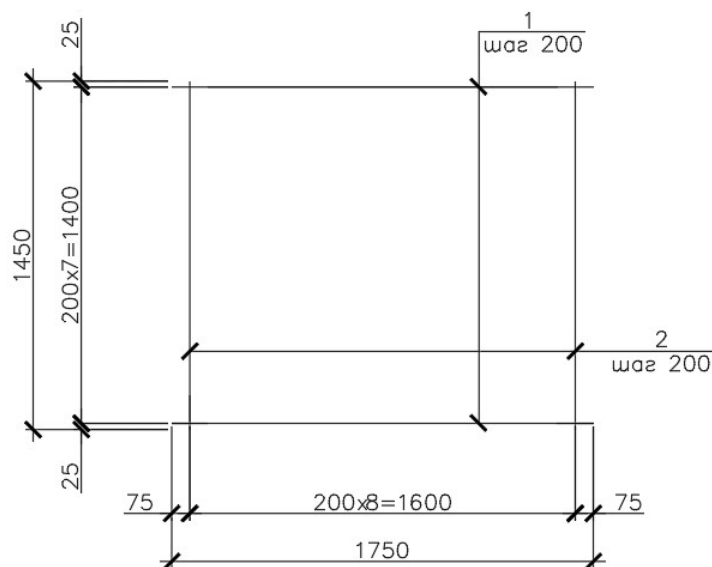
Армирование плитной части столбчатого фундамента , сетка С-1
